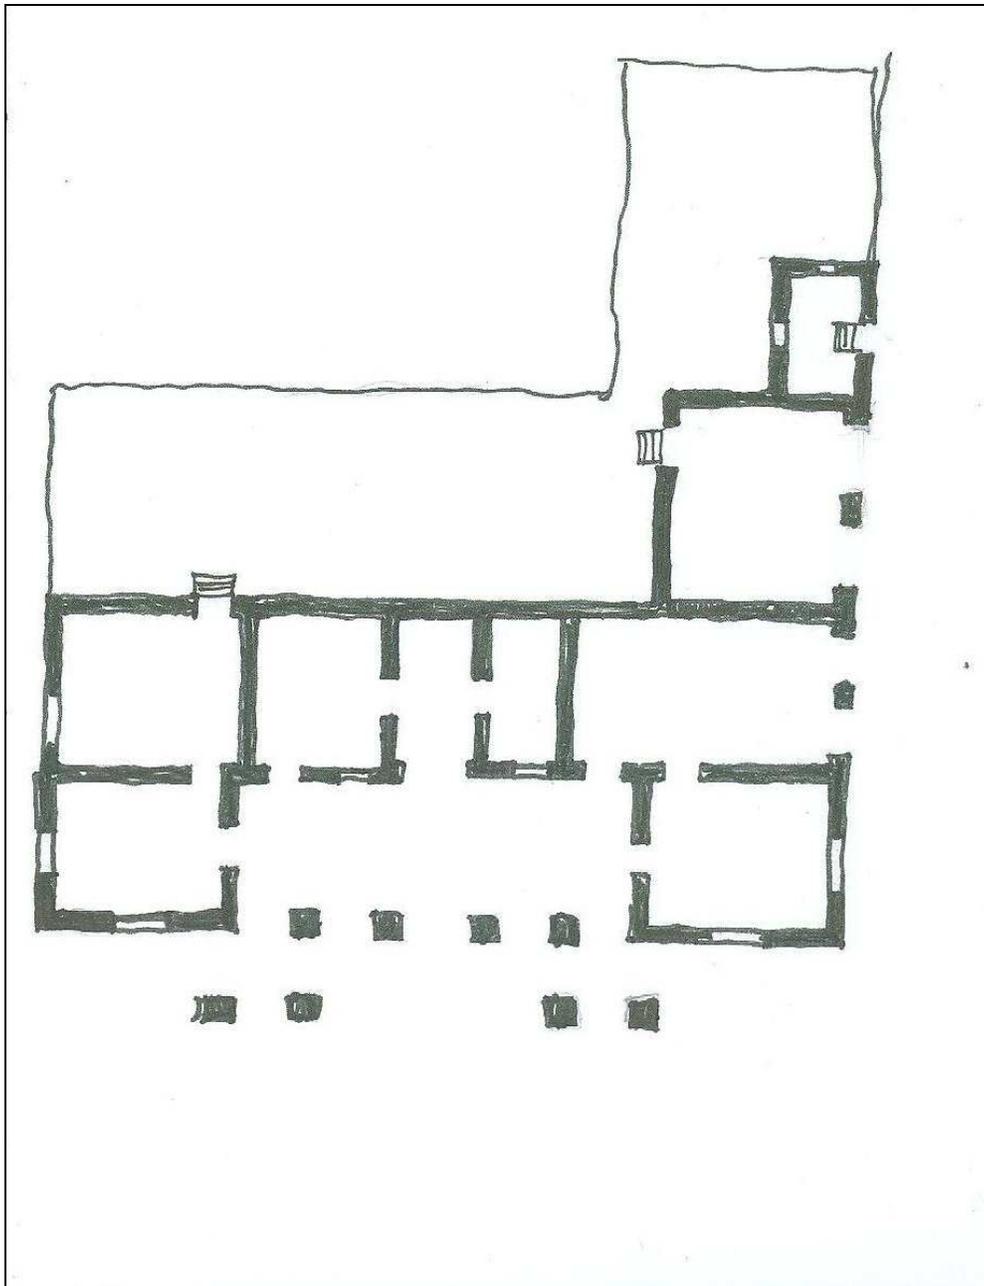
Planta atual do piso térreo da Fazenda Jambeiro.
